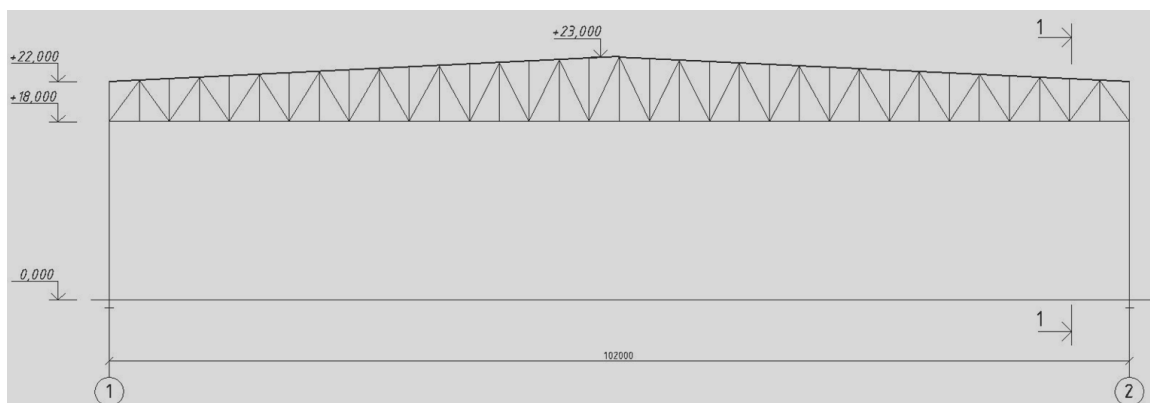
Балочное покрытие из трапециевидных ферм
